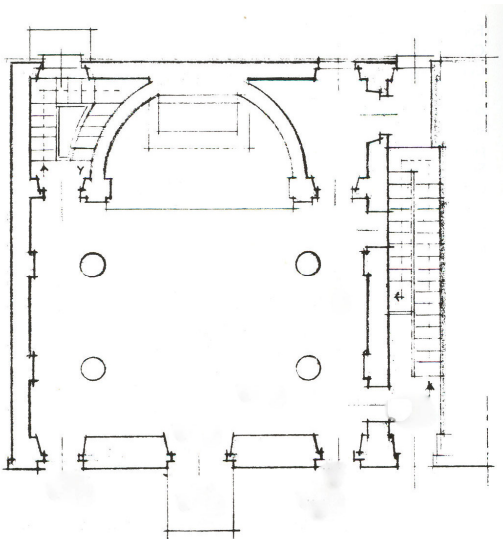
Pianta dell'Oratorio. Rilievo dell'architetto Ivo Maretti. Da Ruberti F. 1991, p. 170.
